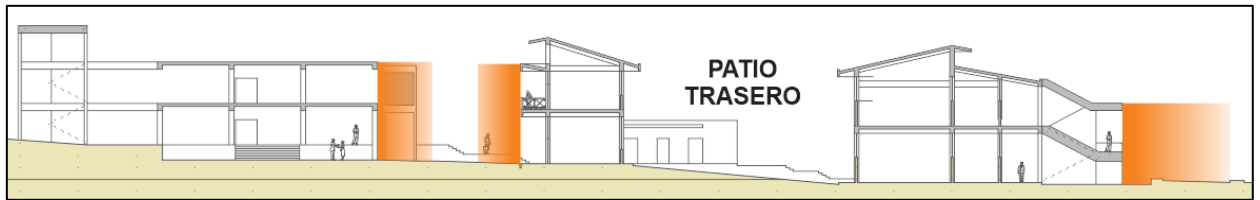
Sección B-B', tramo Facultad de Ingeniería Civil y Arquitectura.
